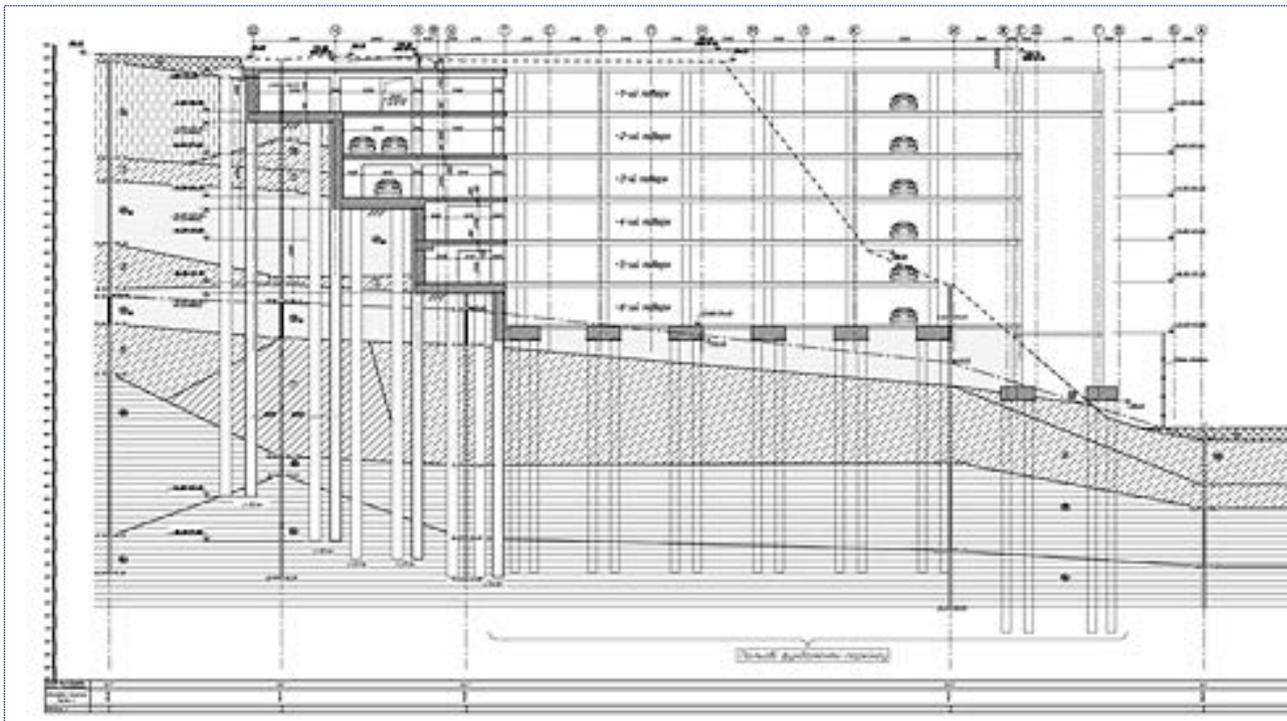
Посадки здания на геологический разрез крутого склона (левый склон поймы реки Лыбидь, г. Киев)
